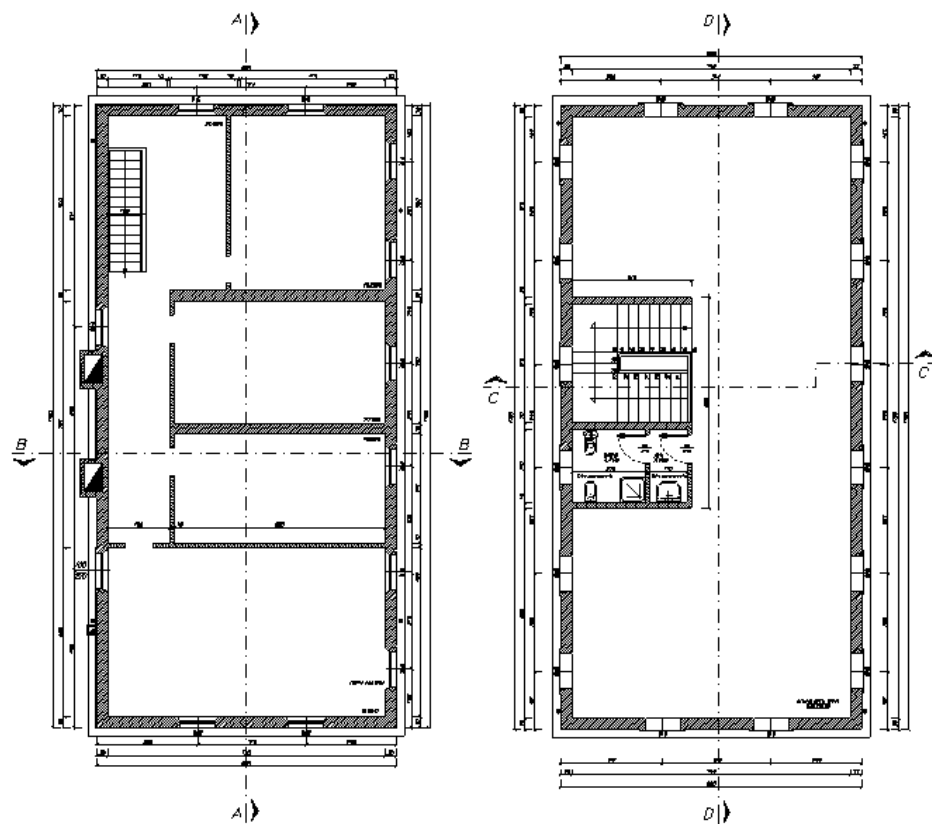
Confronto stato di fatto e di progetto: piante murature piano primo -secondo
